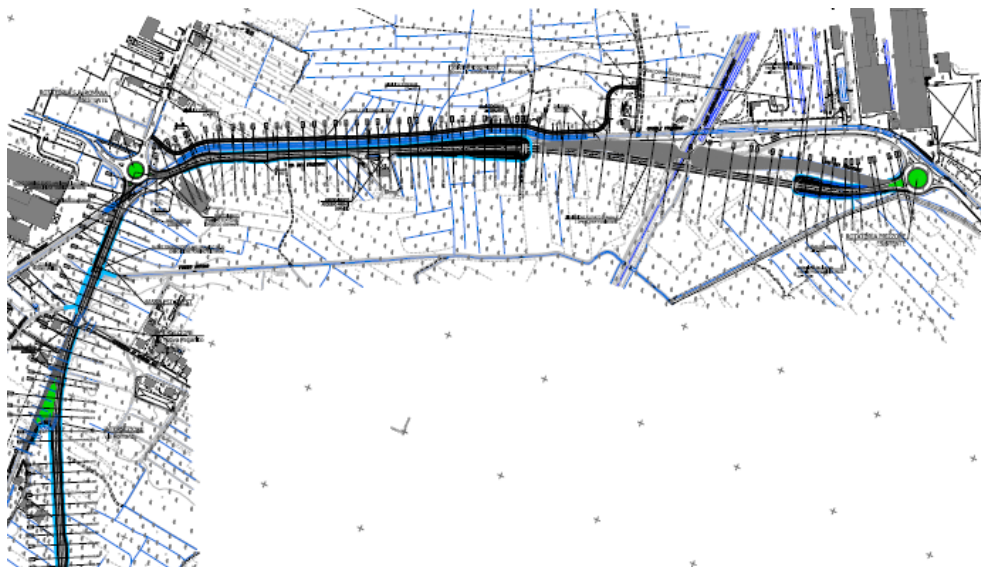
Asse Est-Ovest – Planimetria di progetto stralcio 2/3
